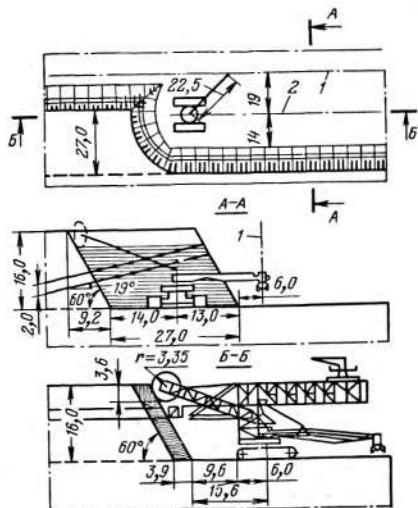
Схема обработки уступа торцовыми заходками нормальной ширины с одного положения оси передвижения роторного экскаватора:
